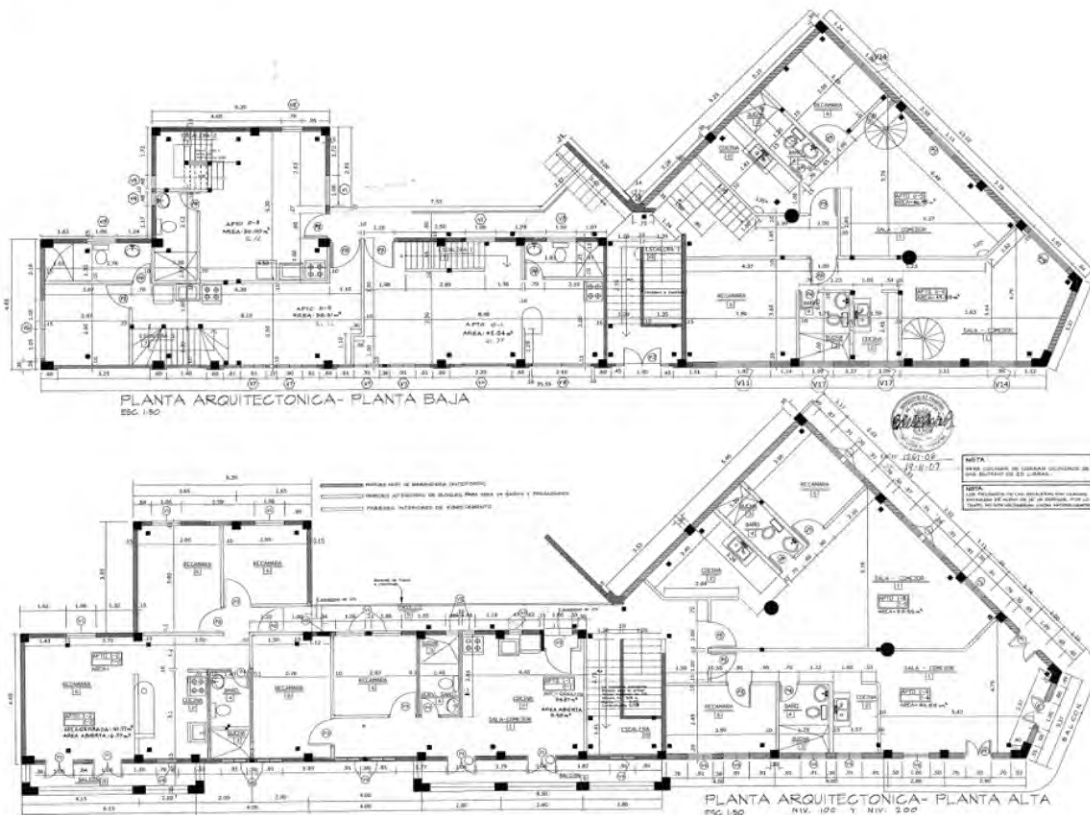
Plantas arquitectónicas del ala del edificio previamente intervenida
